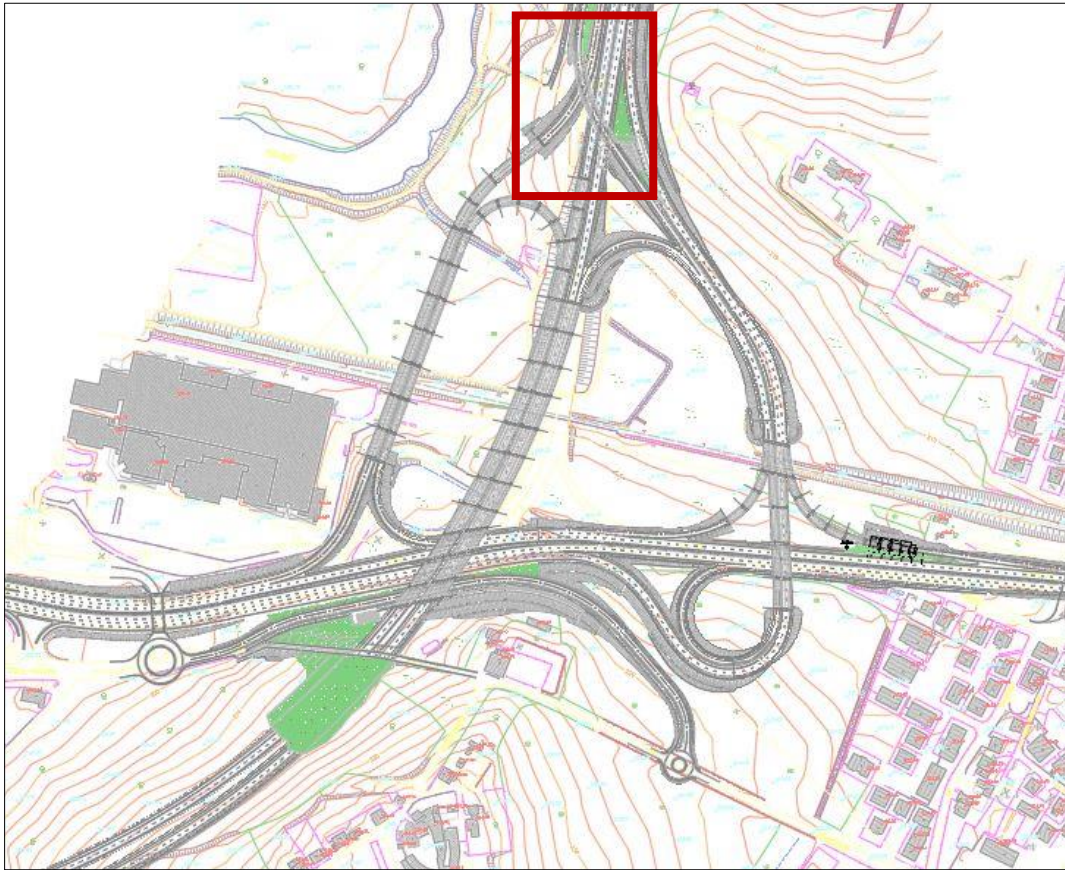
Stralcio planimetrico dello svincolo di Collestrada ed ubicazione sottovia
